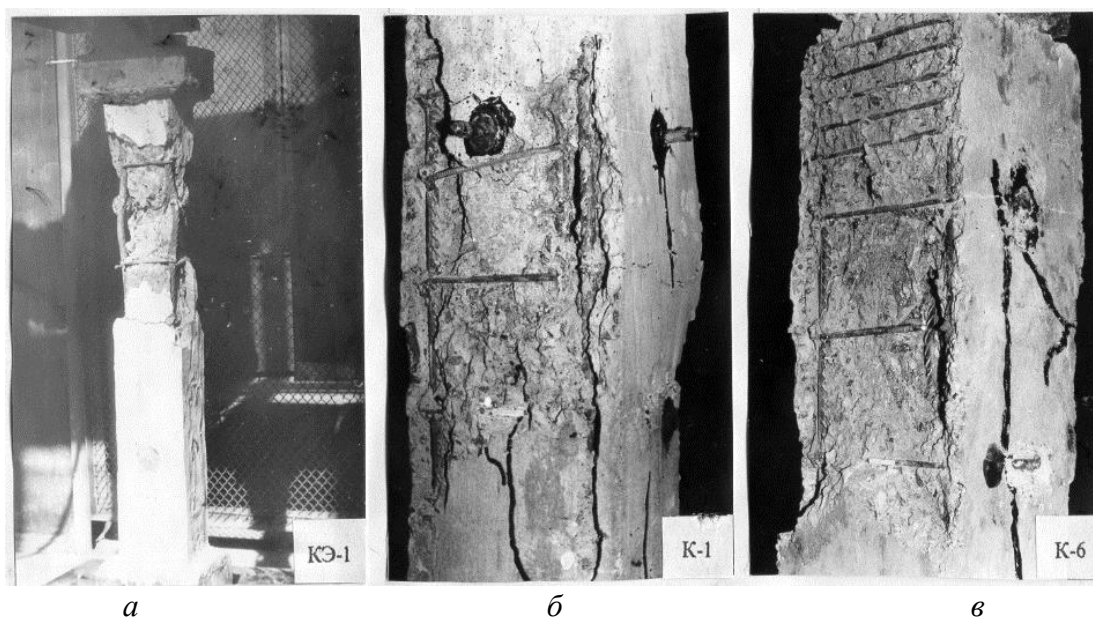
Общий вид разрушения опытных железобетонных элементов
